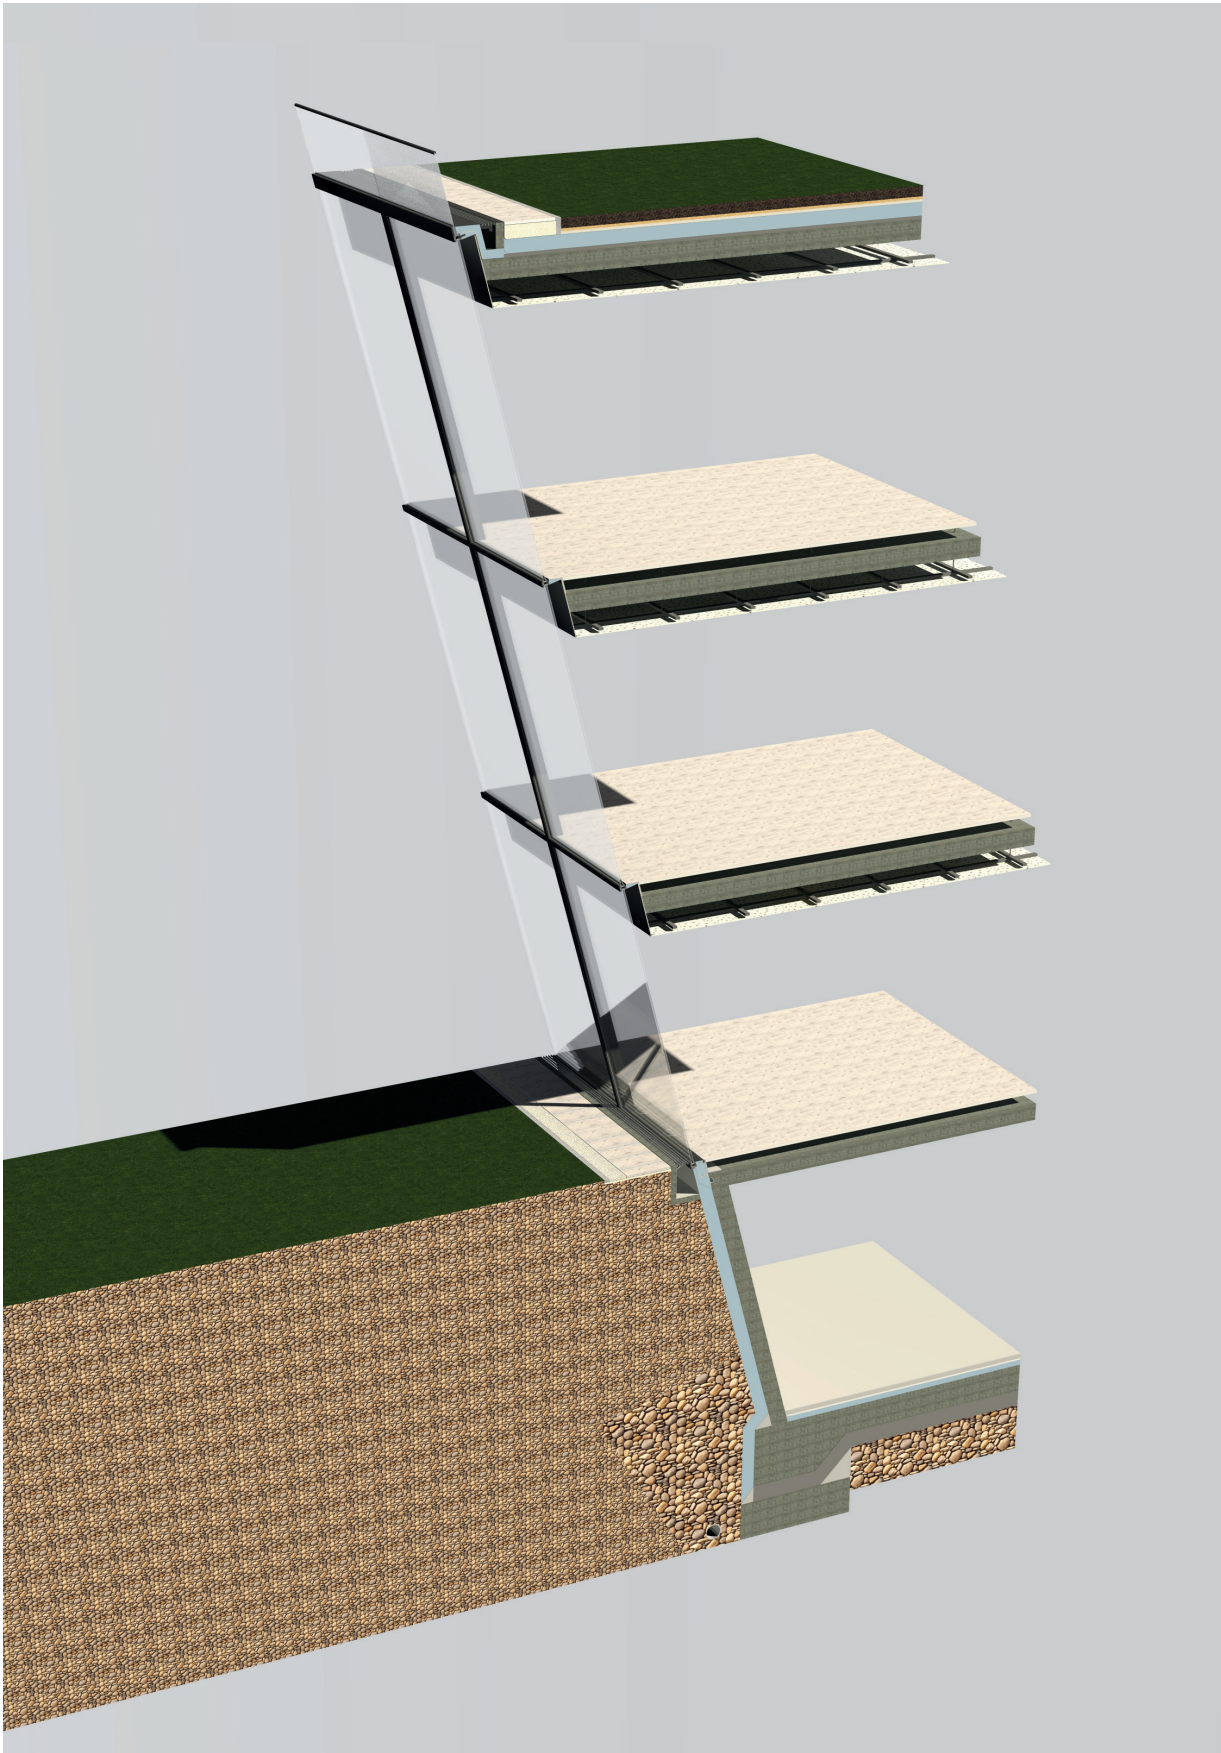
Fassadenschnitt 3D - Gesamtansicht
